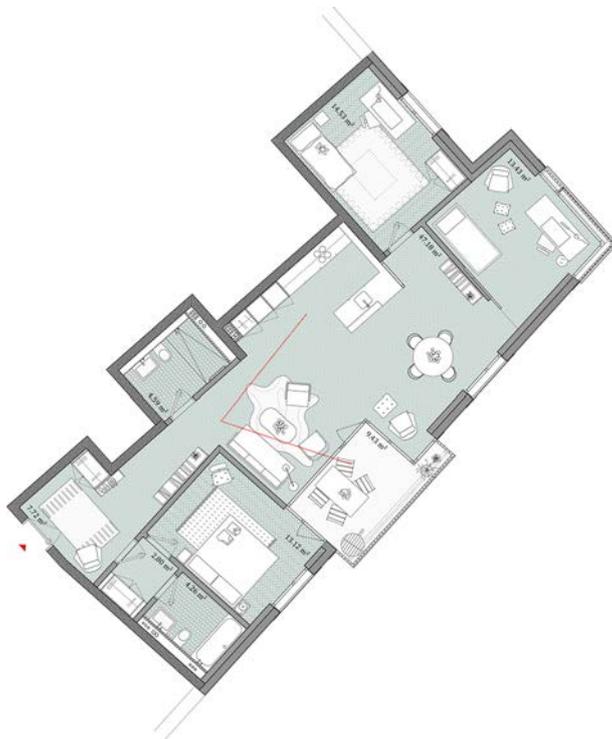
Wohnungsgrundriss 4.5 Zimmer - Whg.
